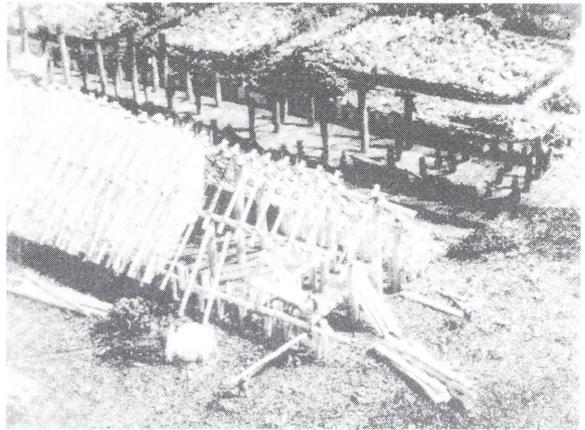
Harting-Nord. Bau eines jungsteinzeitlichen Hauses (Modellausschnitt der Rekonstruktion nach den Ausgrabungsbefunden: im Vordergrund das jüngere Haus 1, dahinter das abgebrannte ältere Haus 2. Modellmaßstab 1:75; Entwurf/Bau v. Brandt); [aus: RIECKHOFF-PAULI 1987, Abb. 19].
